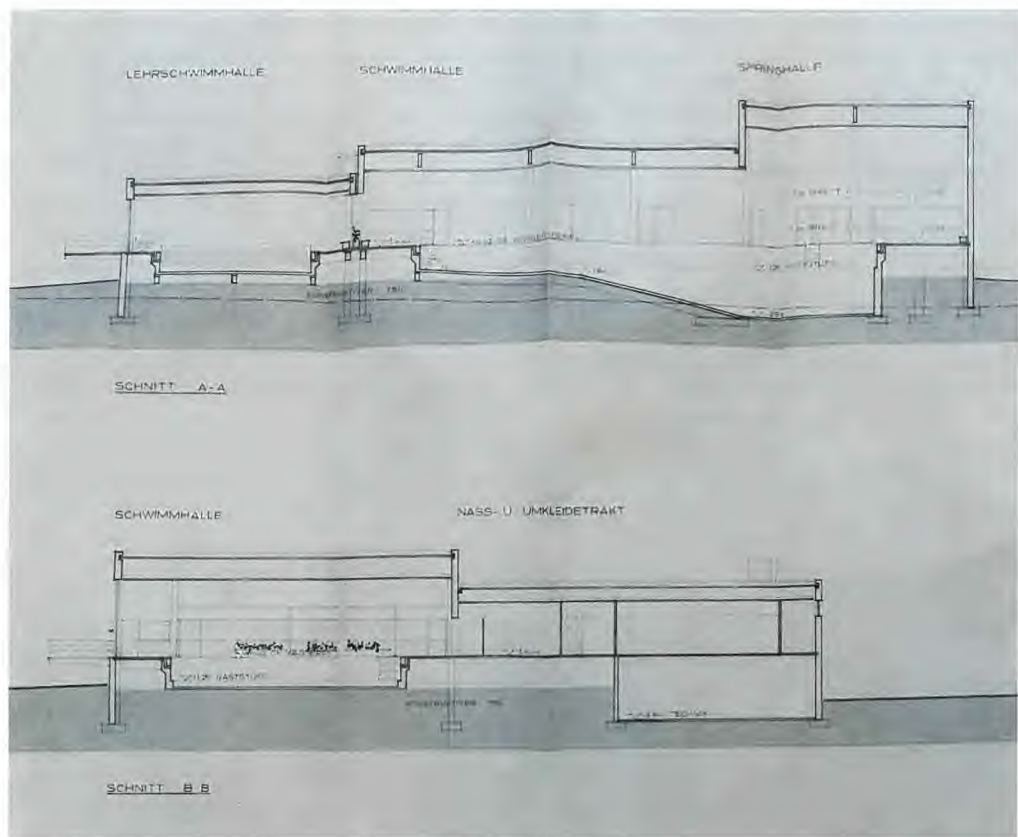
Querschnitt Planung Hallenbad Neubau 1970. Plan in Stadtarchiv, Akten nach 1945, IG Hallenbad Dachau e. V., Signatur 000 644. Repro: Autor
